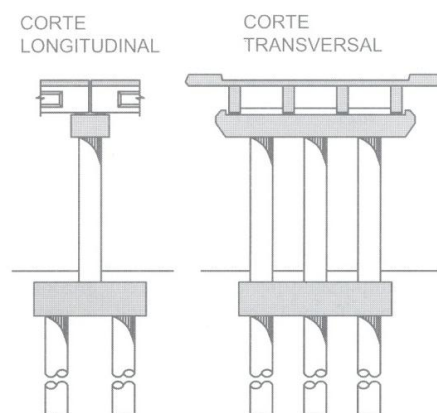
Pilar con columnas múltiples fundado con pilotes
